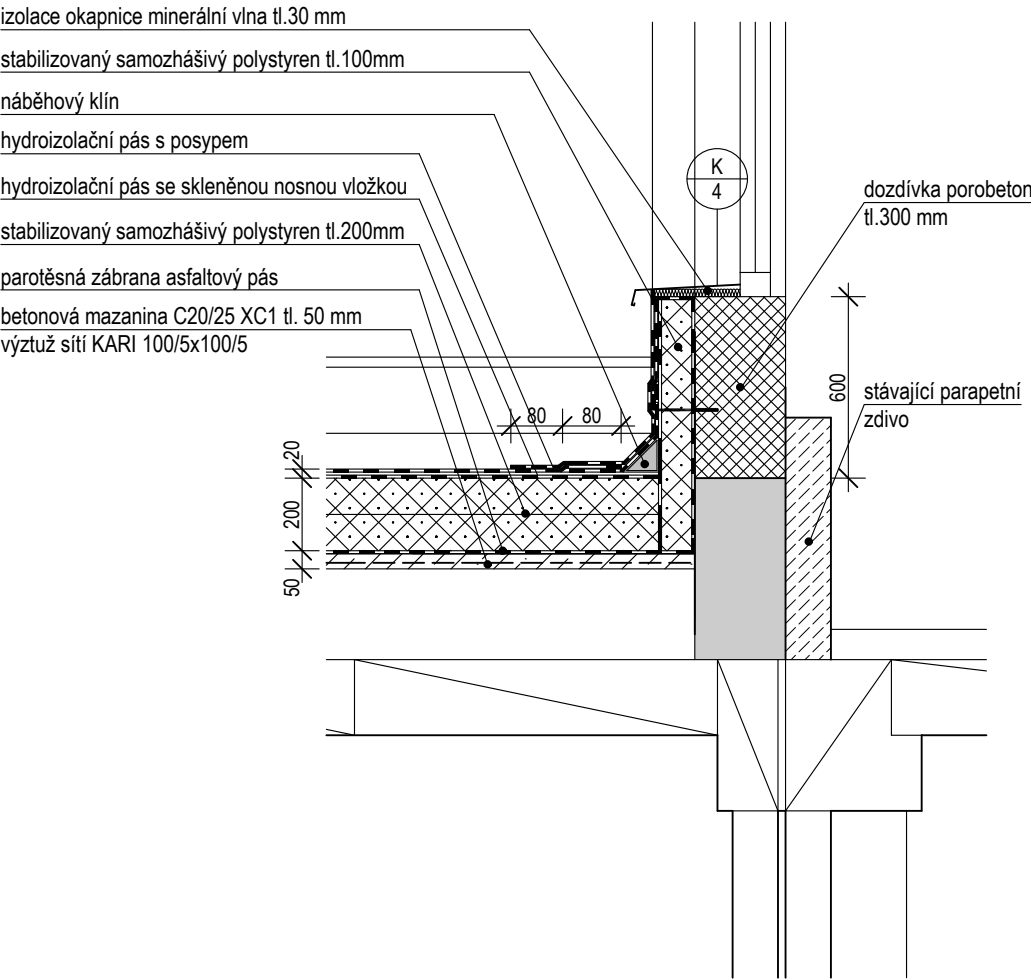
DETAIL B - UKONČENÍ STŘECHY - ATIKA š.400 mm
